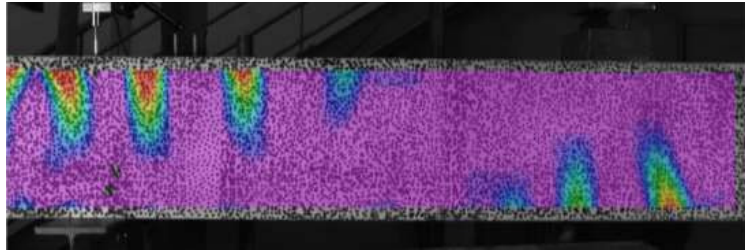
Exemple de fissures verticales dans la partie inférieure de la poutre NS-15 provoquées par l'application du chargement transversal
